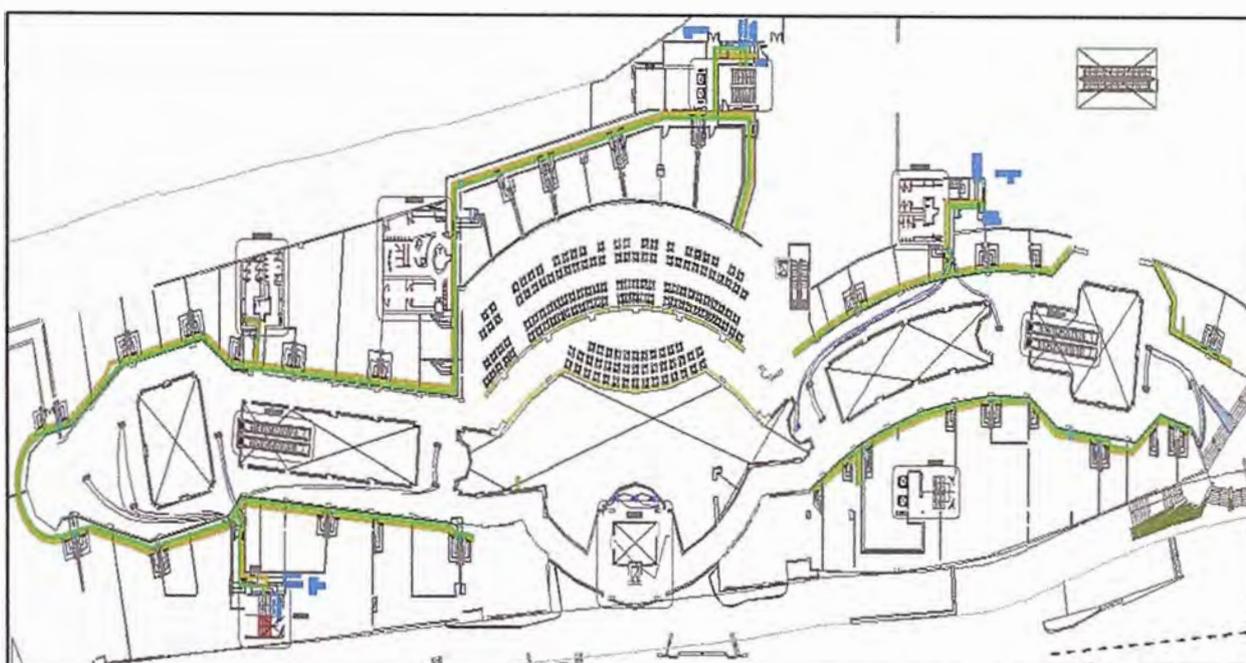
Plano de la segunda planta del C.C. Comercial Parque Lambramani. Fuente: Elaboración propia.
